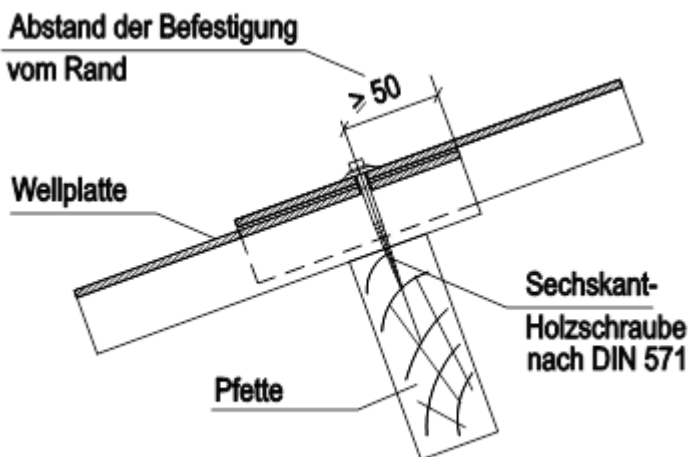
Befestigung auf einer Holzpfette mit einer Sechskant-Holzschraube nach DIN 571
